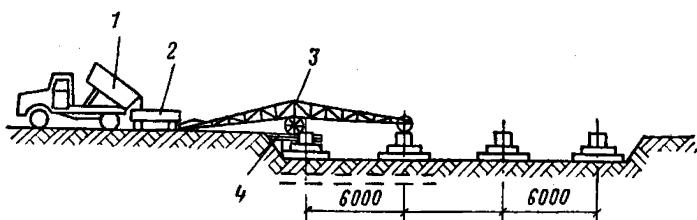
Схема бетонирования фундаментов с помощью ленточного конвейера
